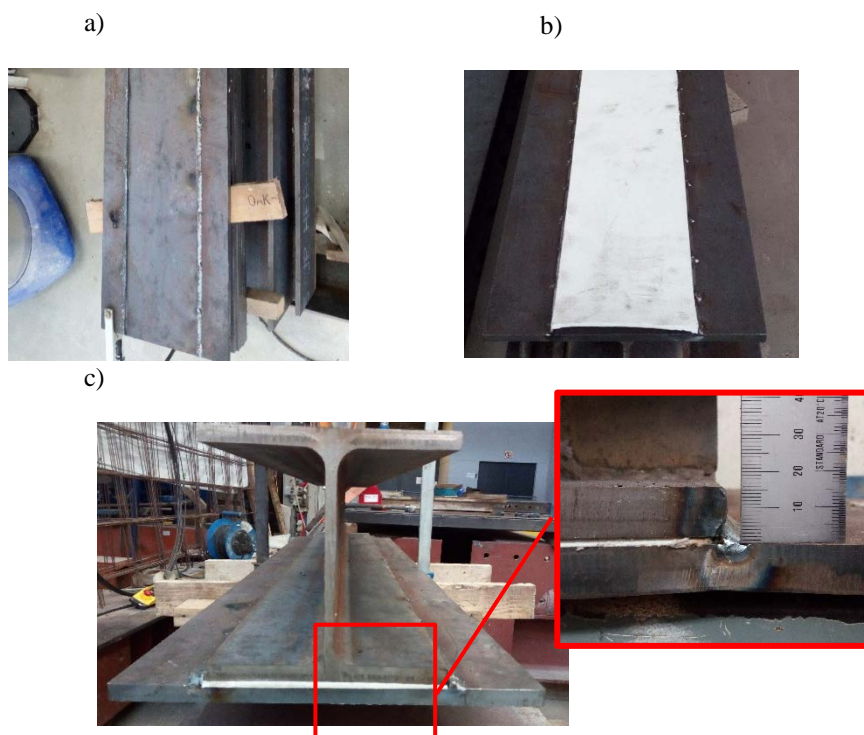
Procedimiento de fabricación de la viga slim-floor propuesta.
